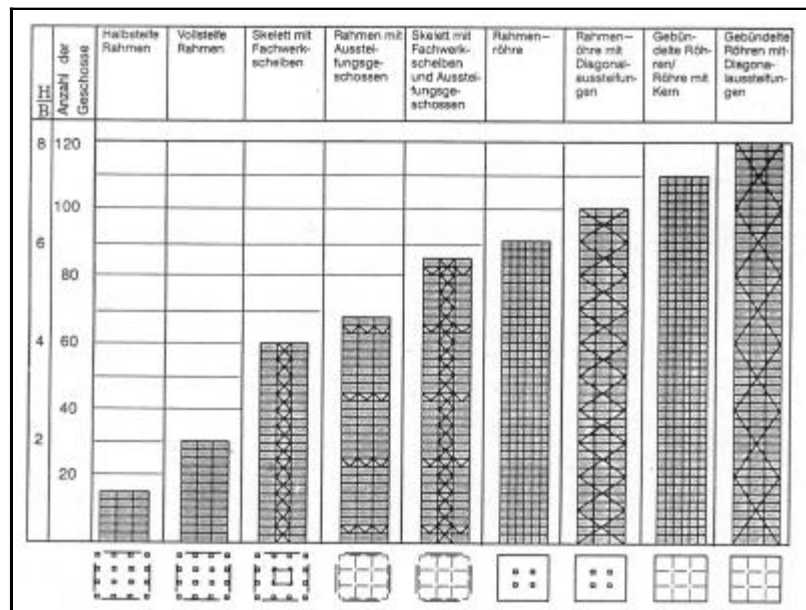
Konstruktionsformen und Gebäudehöhen
